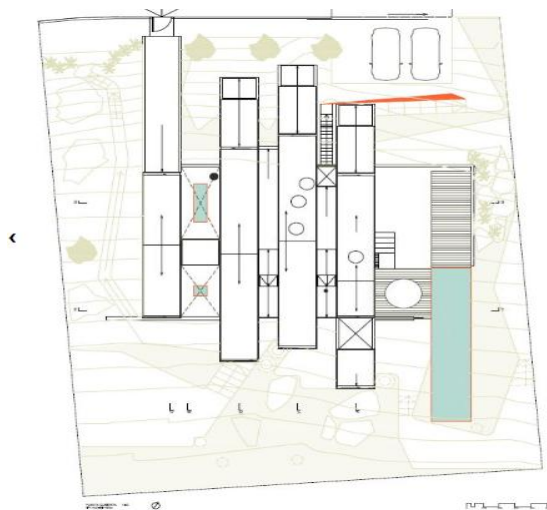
PLANTA ARQUITECTÓNICA CASA ORUGA
